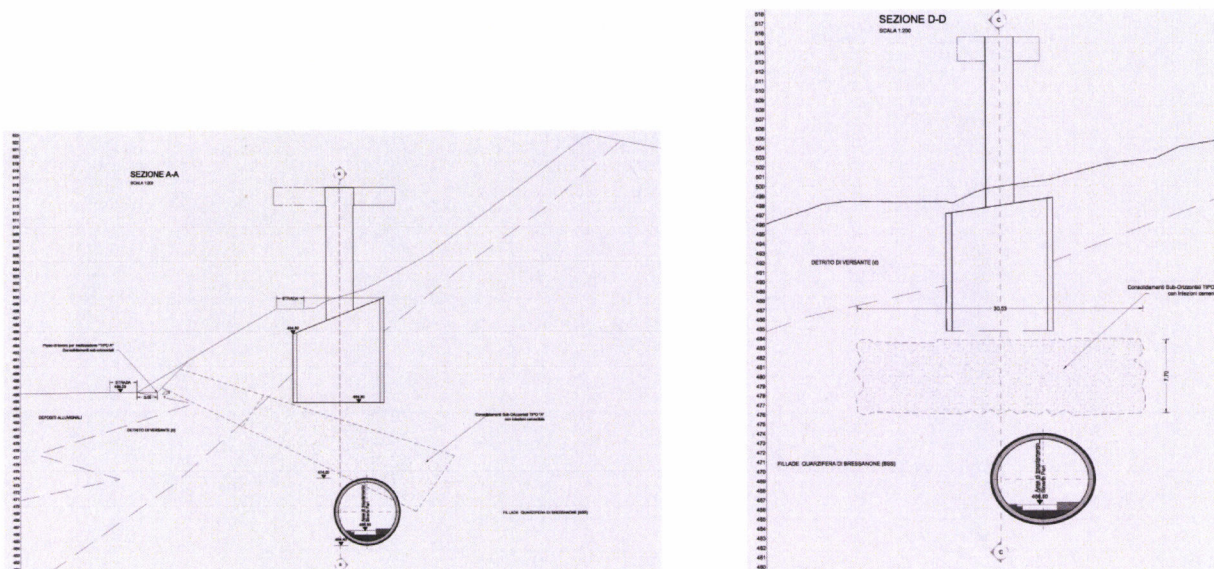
Sezioni trasversali - Geometrie degli interventi sotto la fondazione della pila 13
